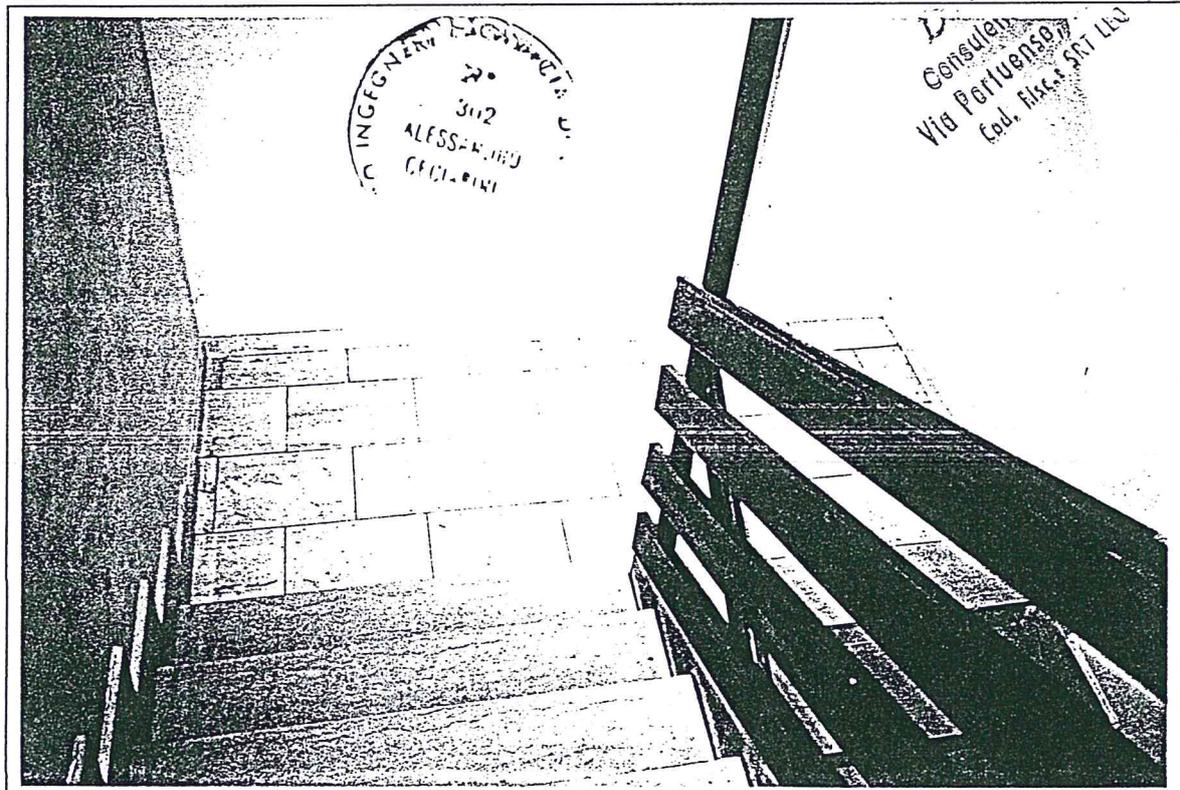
Vista del pianerottolo intermedio delle rampe scala.
